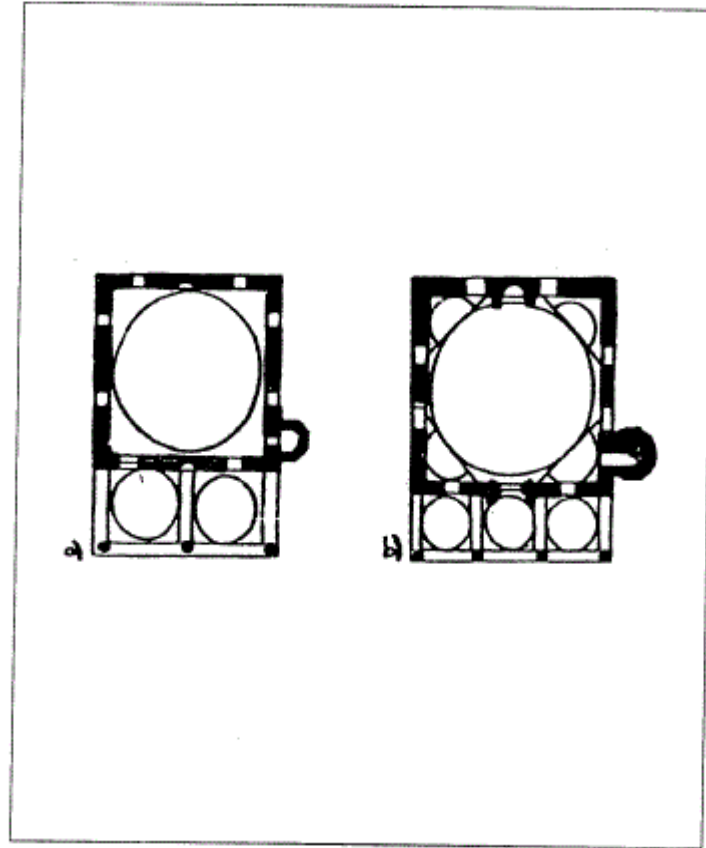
مسقط أفقي لمسجد الفايّاز في برشتينا (عن : اصلان ابا) .
